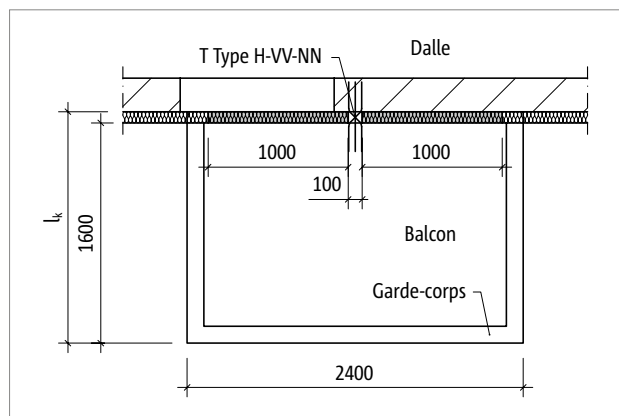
Schöck Isokorb® T type K-E, K-T avec Type T : Système statique, plan de base
